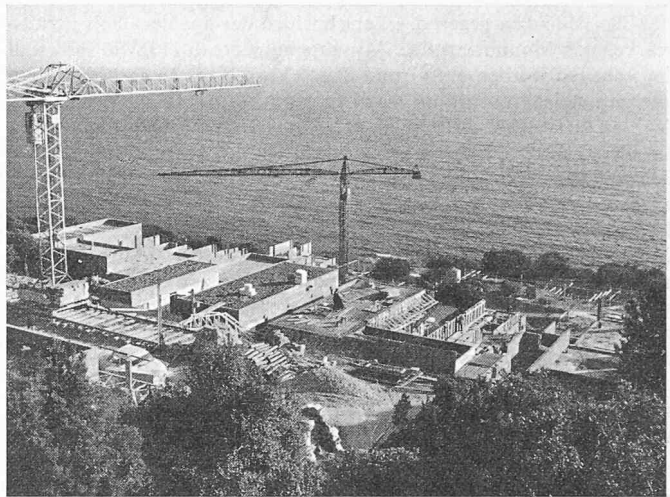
Ansicht der Baustelle Village du Merlier im Mai 1964
